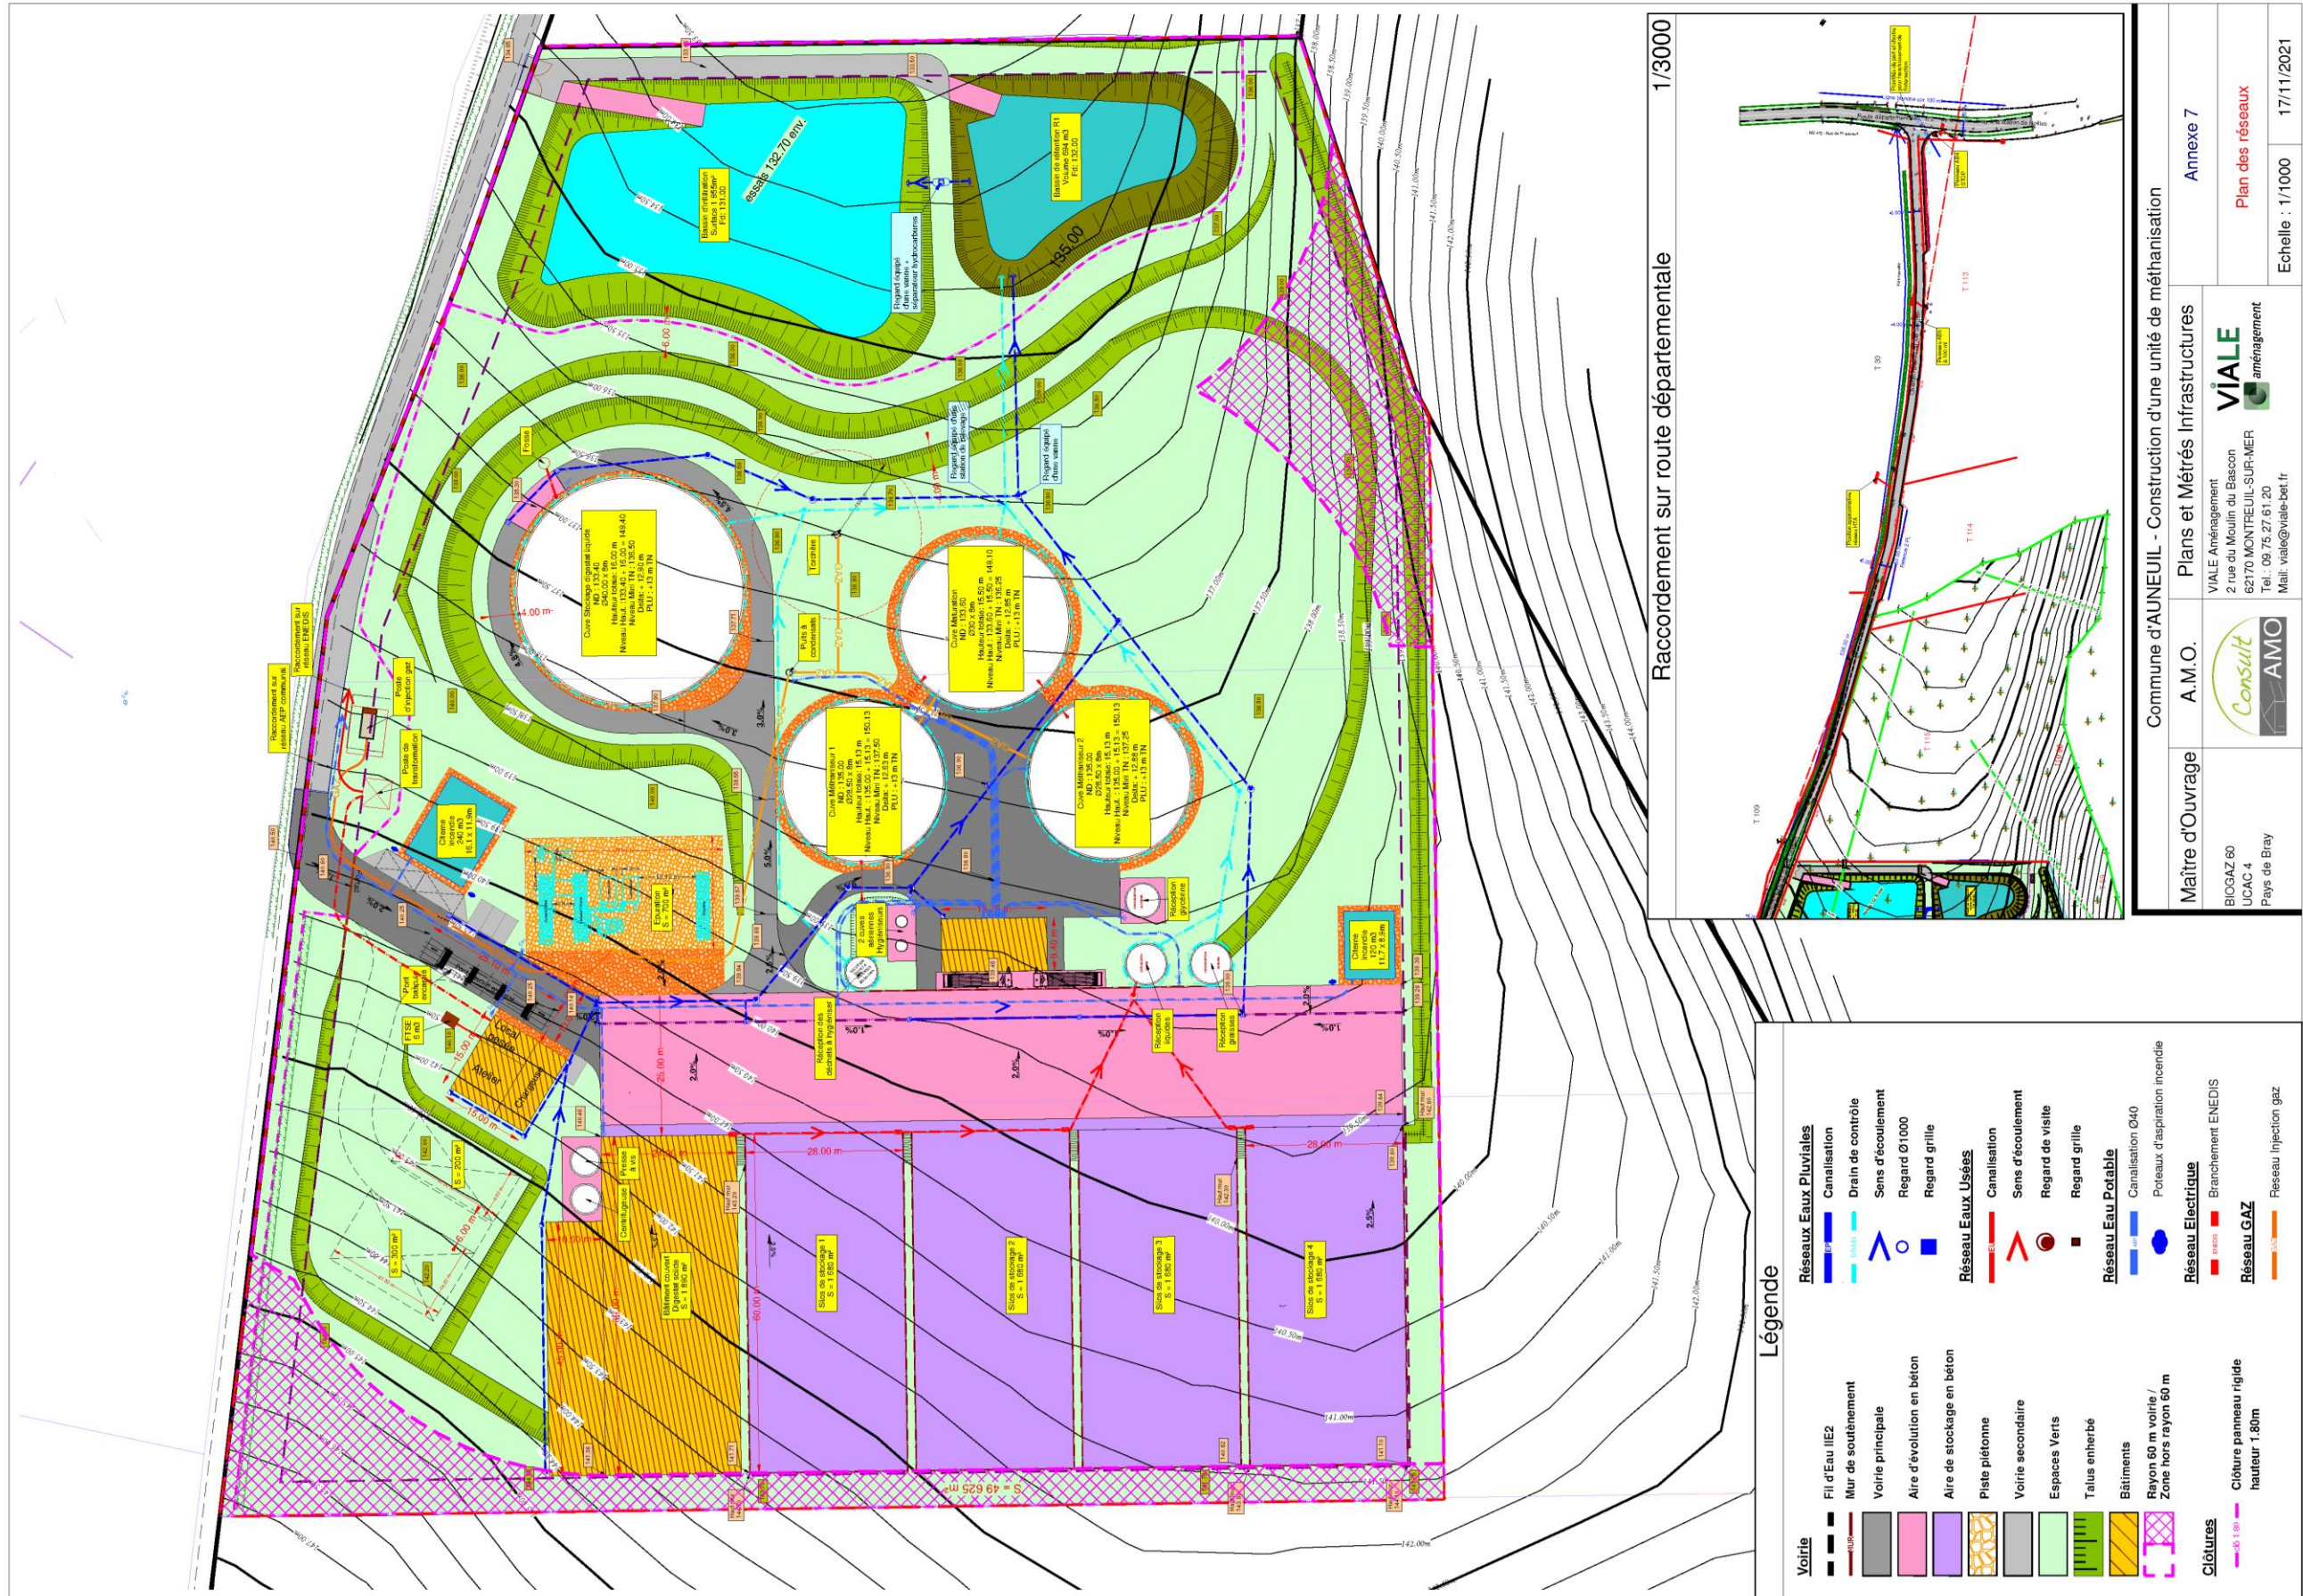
Plan de masse de l'installation (source : VIALE, 2021)
